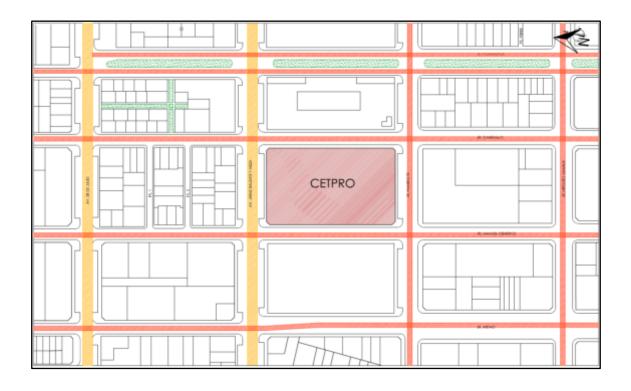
Tipo de vías aledañas al terreno escogido Elaboración: la autora
